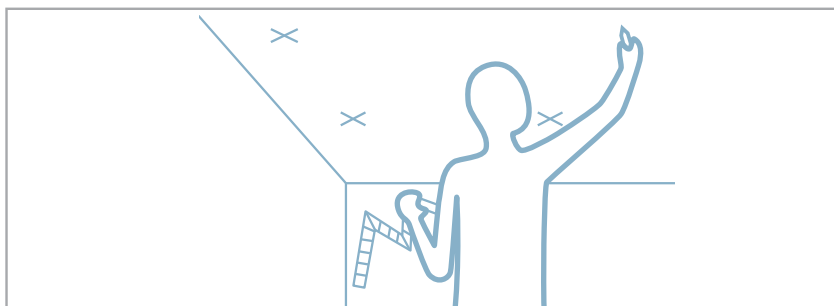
Marquer d'un repère au plafond l'endroit exact de vos points de fixation.
